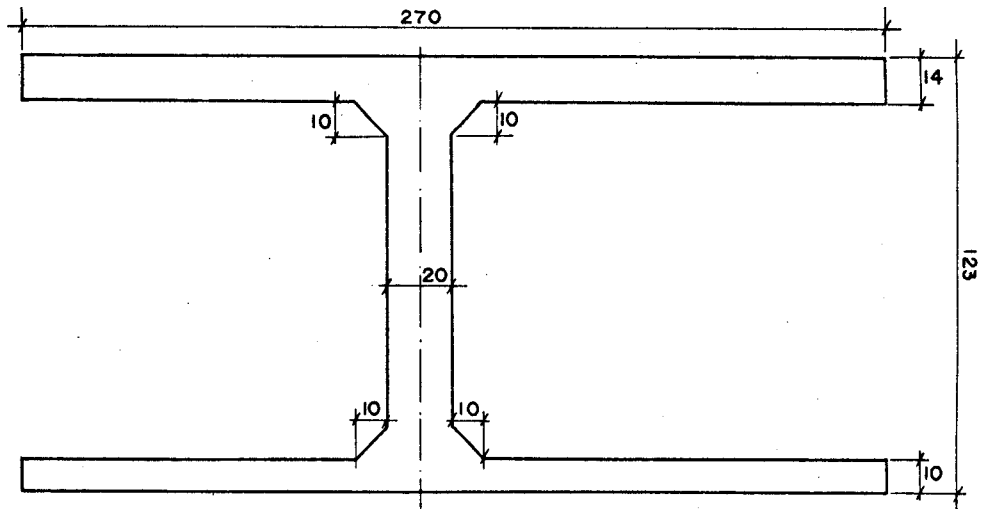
SEÇÃO TRANSVERSAL DA VIGA V3
